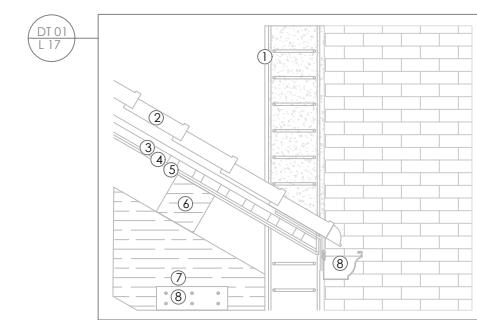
Corte por muro y Detalles constructivos - Elaborado por el autor.
